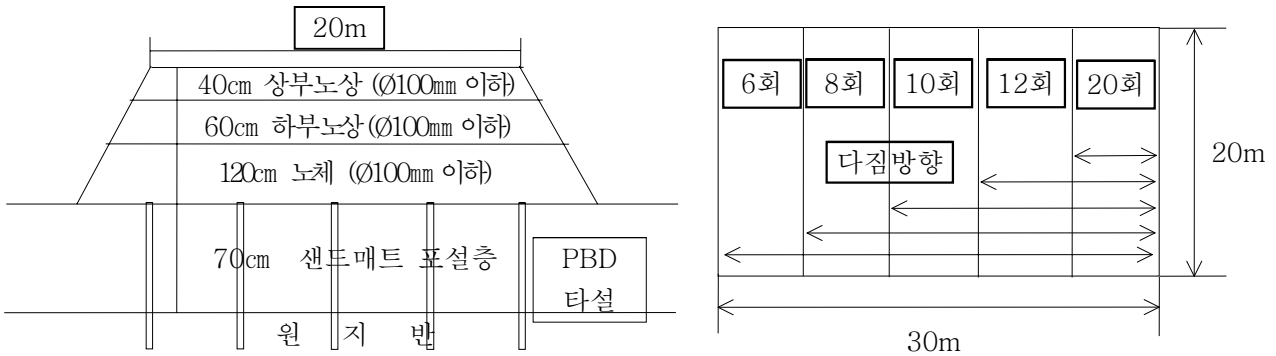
시험다짐 시공 표준단면 및 다짐횟수 구역별 평면도
